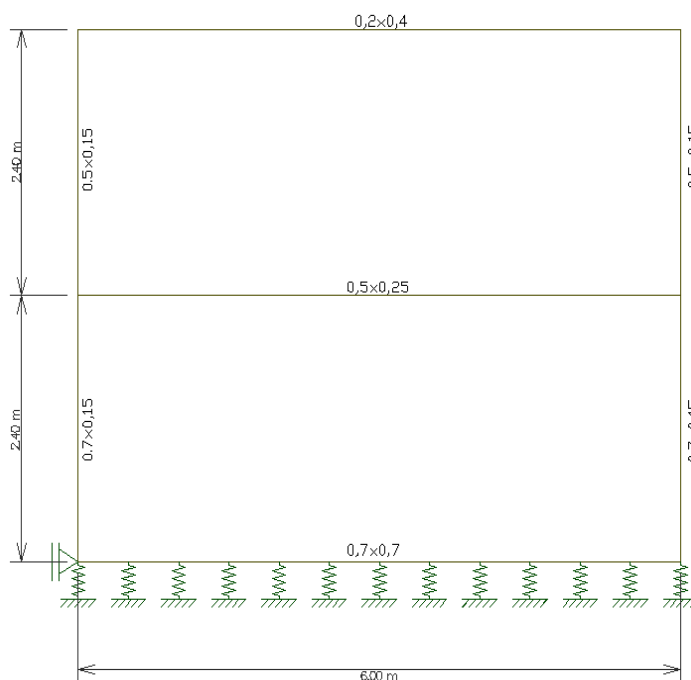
Dimensões e geometria das vigas e pilares do pórtico 3-3'
